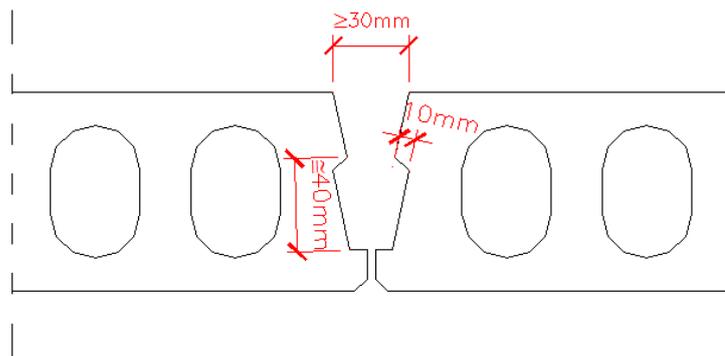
Disposições construtivas para as chaves de cisalhamento (Fonte: Antunes, 2011)
